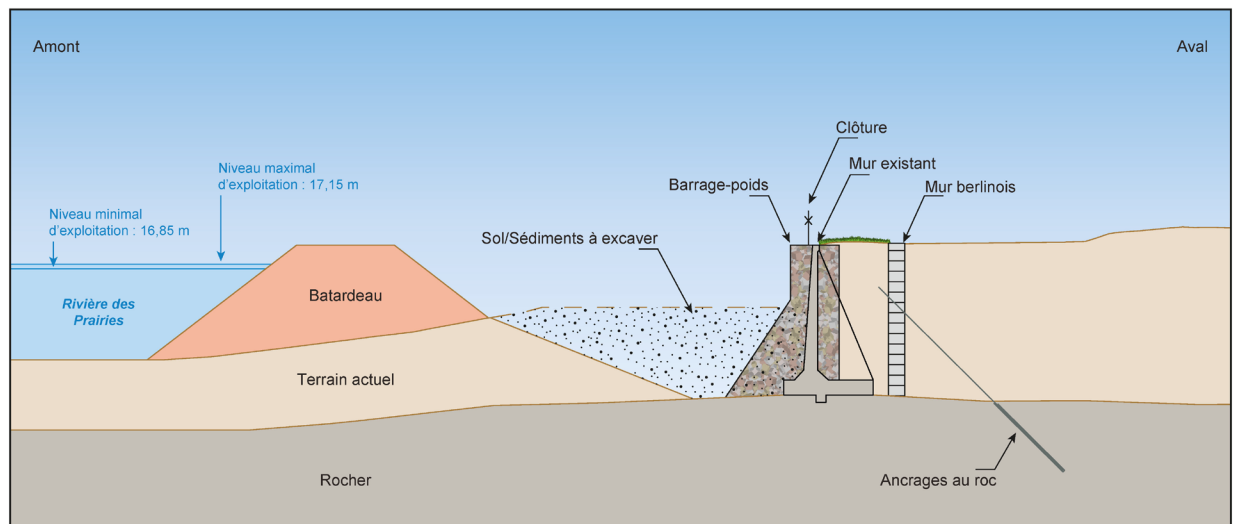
Nouveau barrage au même endroit que le mur existant
